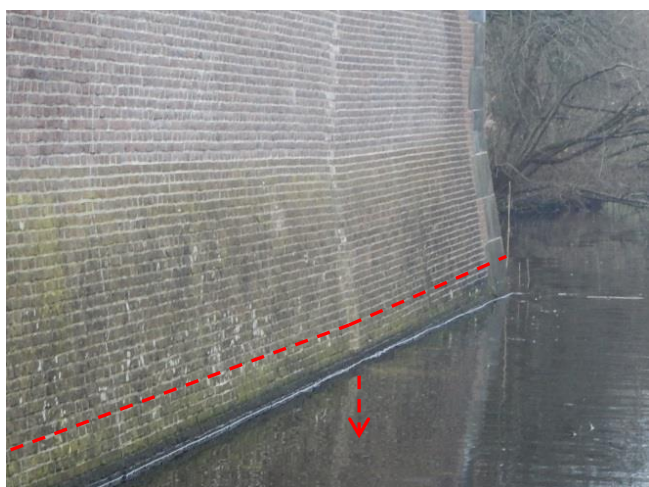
verticale zetting zichtbaar in lintvoegen wand H
